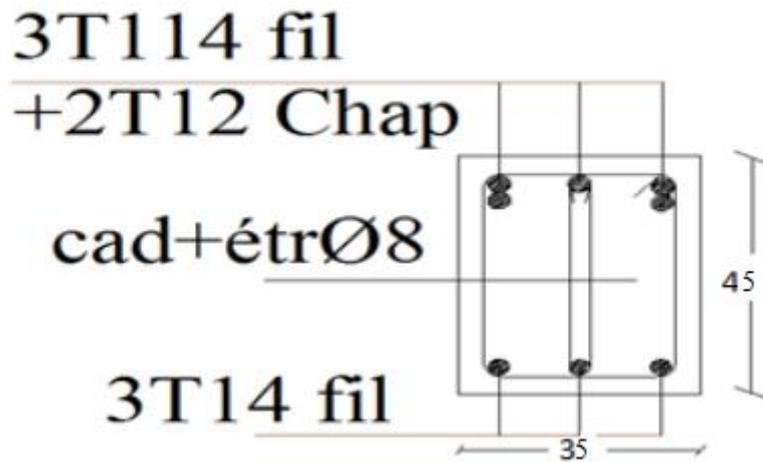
Dessin de ferrailage des sections des poutres principales.
